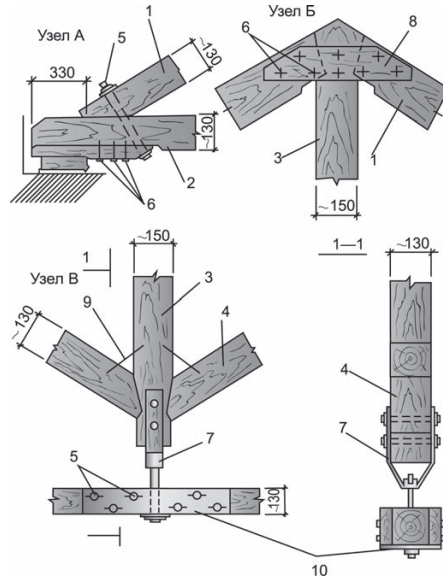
Узлы элементов висячих стропил: 1 — стропильная балка; 2 — затяжка; 3 — бабка; 4 — подкос; 5 — болт; 6 — гвоздь; 7 — хомут; 8 — деревянная накладка; 9 — скоба; 10 — металлическая накладка
